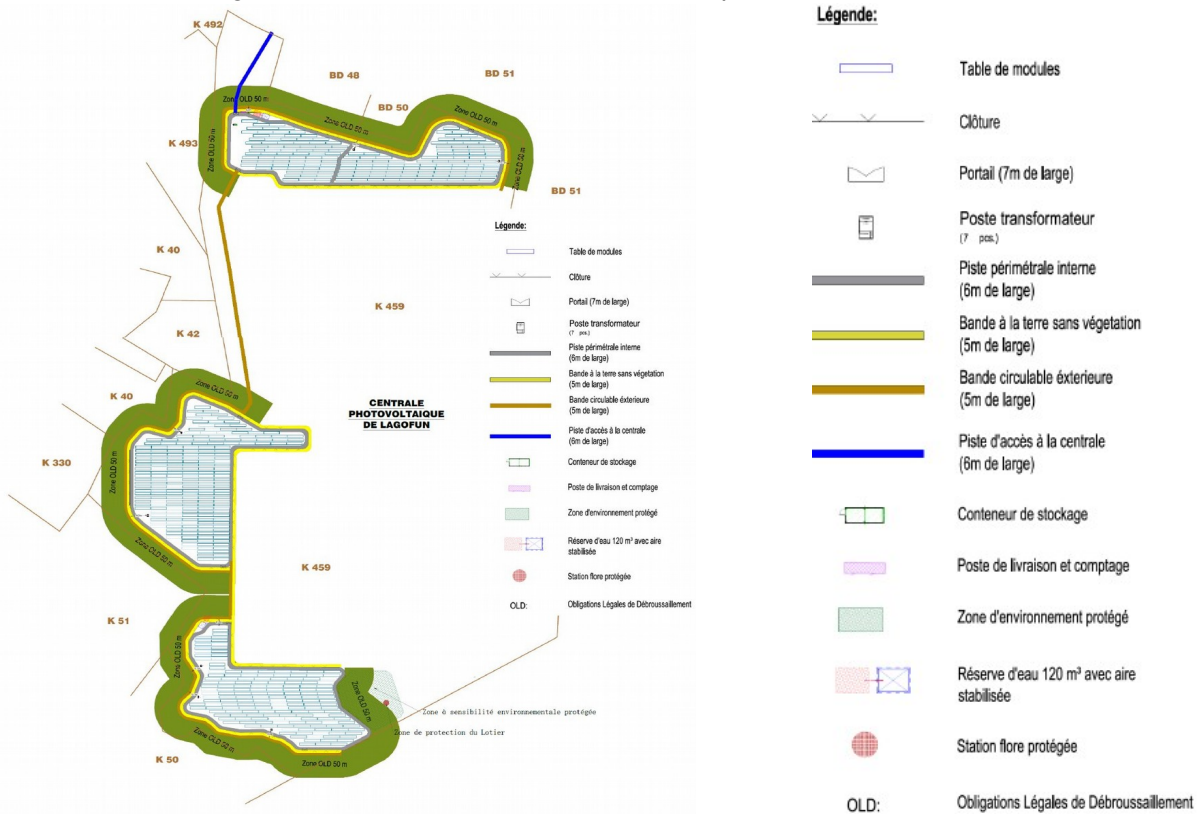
Plan d'implantation du parc photovoltaïque (Source : BayWa.r.e.)
